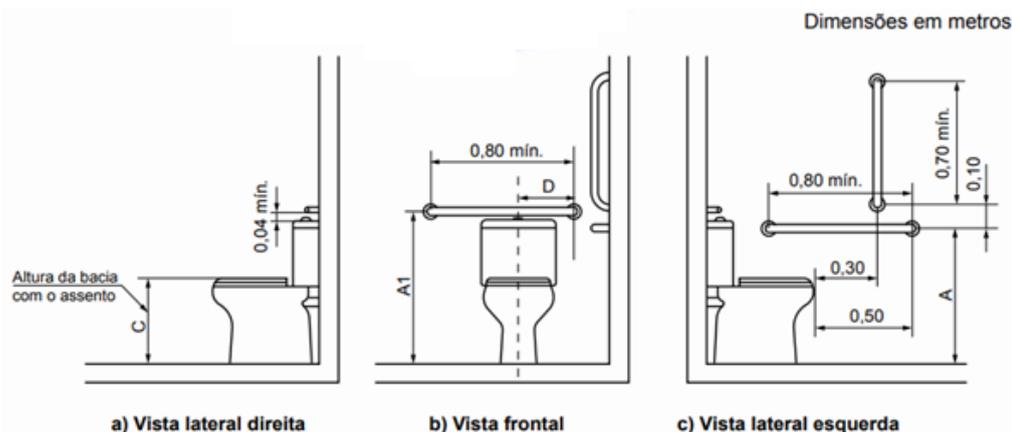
Posição das barras de apoio em relação à bacia sanitária.
